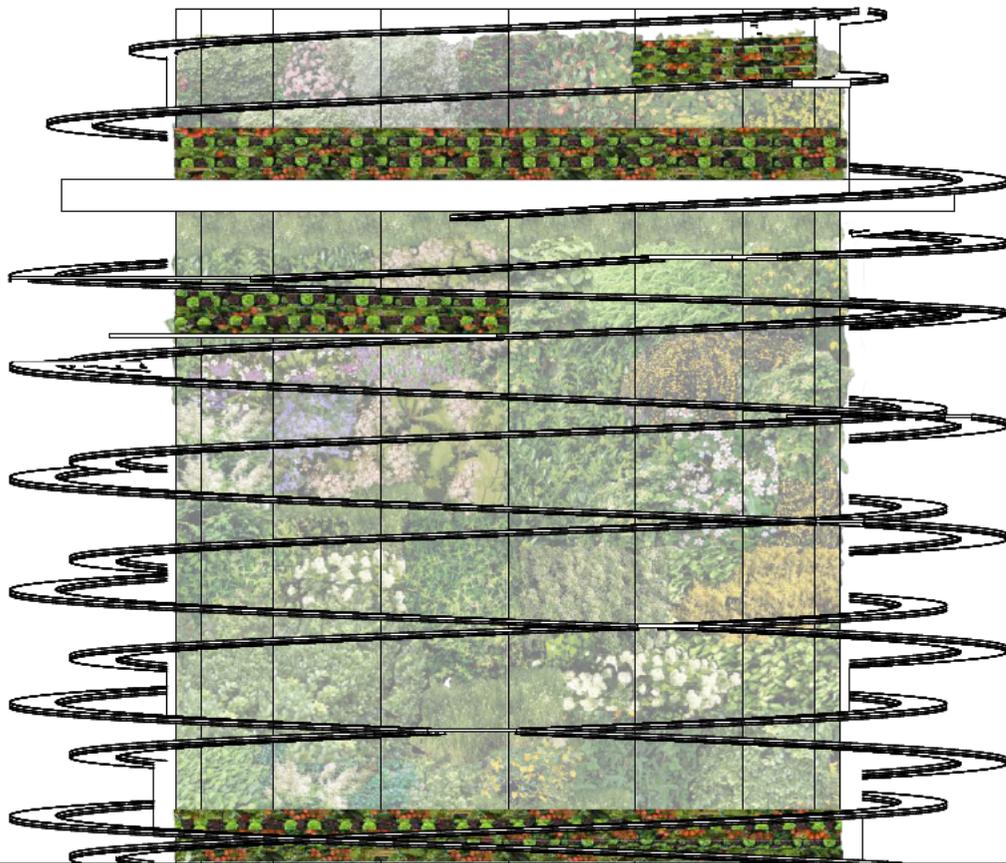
Süd Fassade, Fassadenbegrünung
